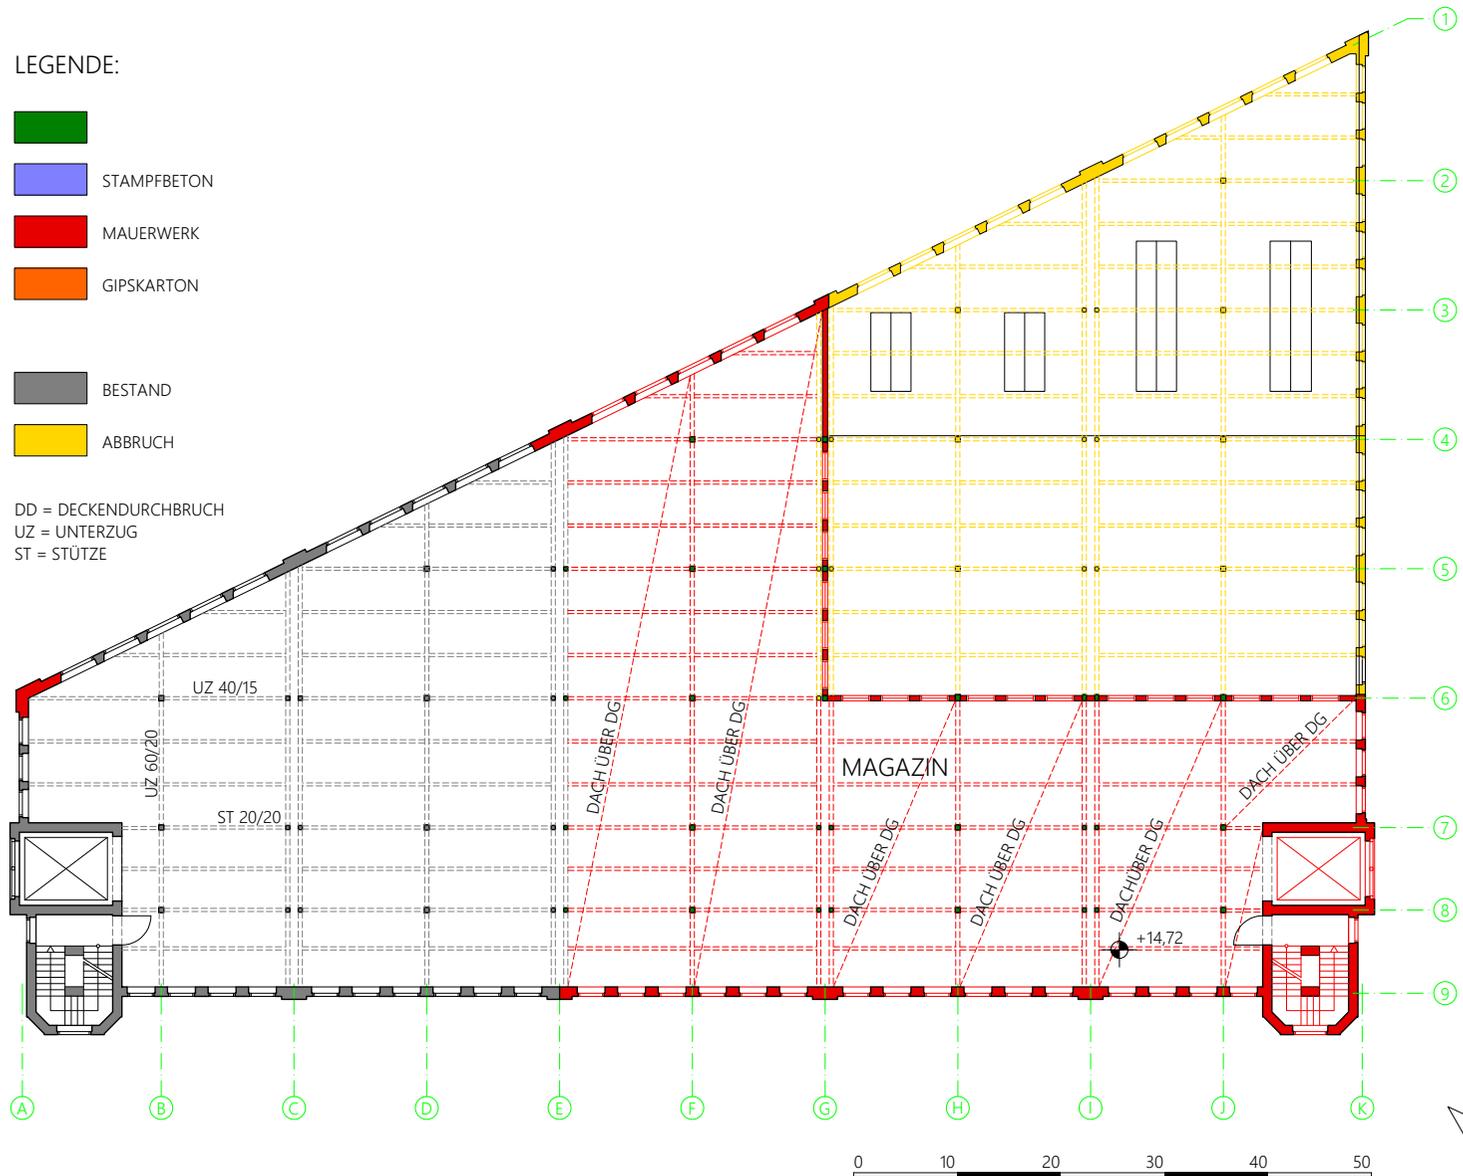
Bauphasenplan 1957: Dachgeschoß des Maschinenmagazins
